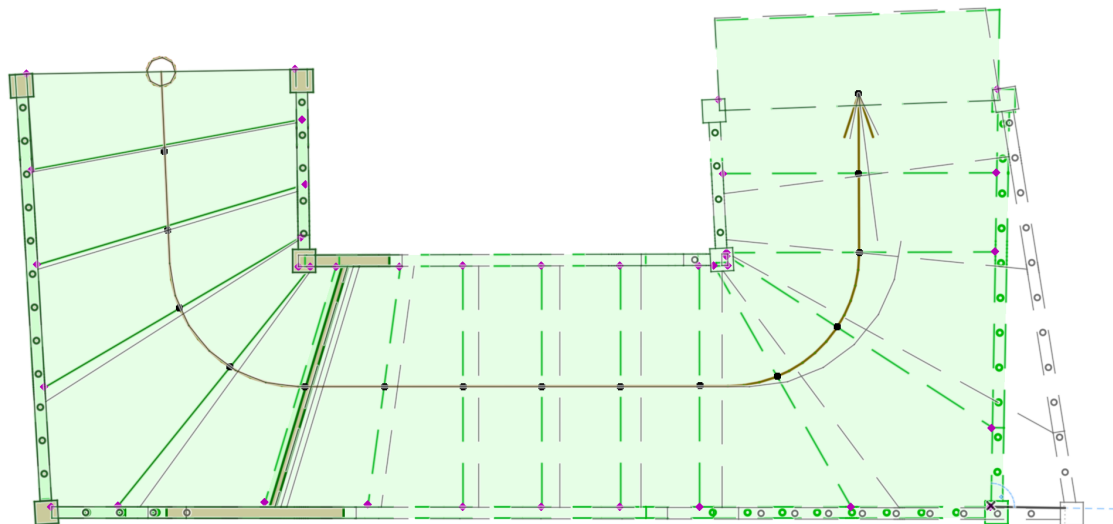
· Grundriss nach dem Ziehen der Kontur — Fangpunkte an den acht Eckpunkten, Stufen, Lauflinie und Bruchlinie folgen sofort.
